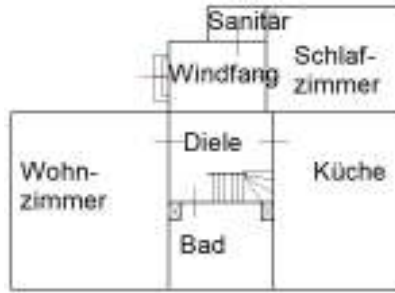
Grundrisssskizze Erdgeschoss
